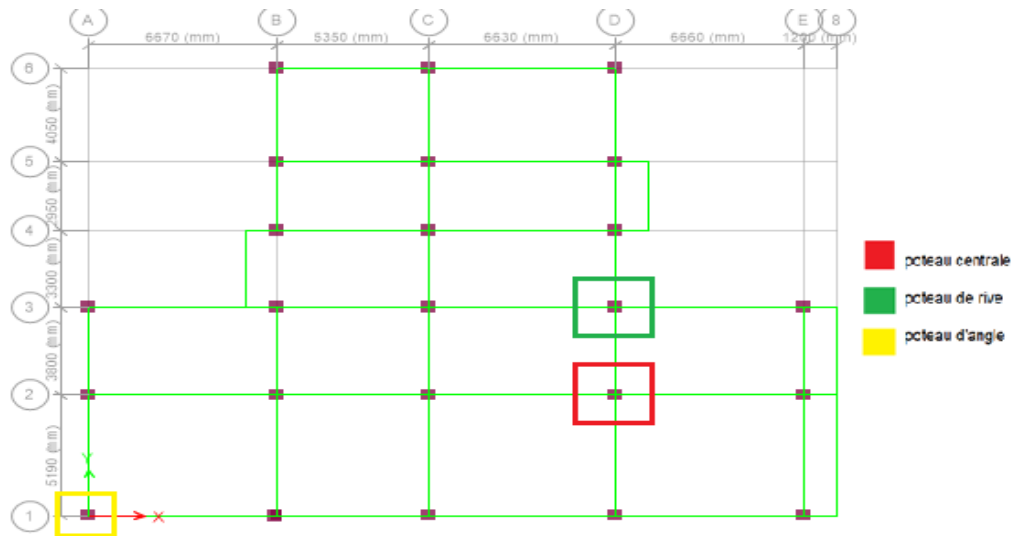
Plan de repérage des poteaux les plus sollicités dans le plan.
